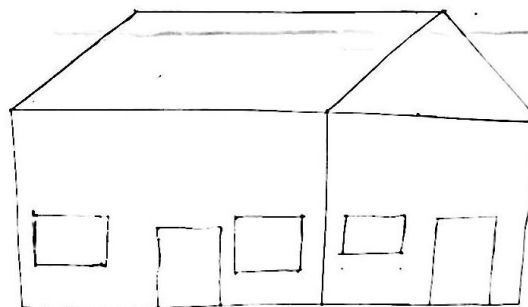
Croqui fachada da Av. do Contorno. Fonte: Autora. 2020
